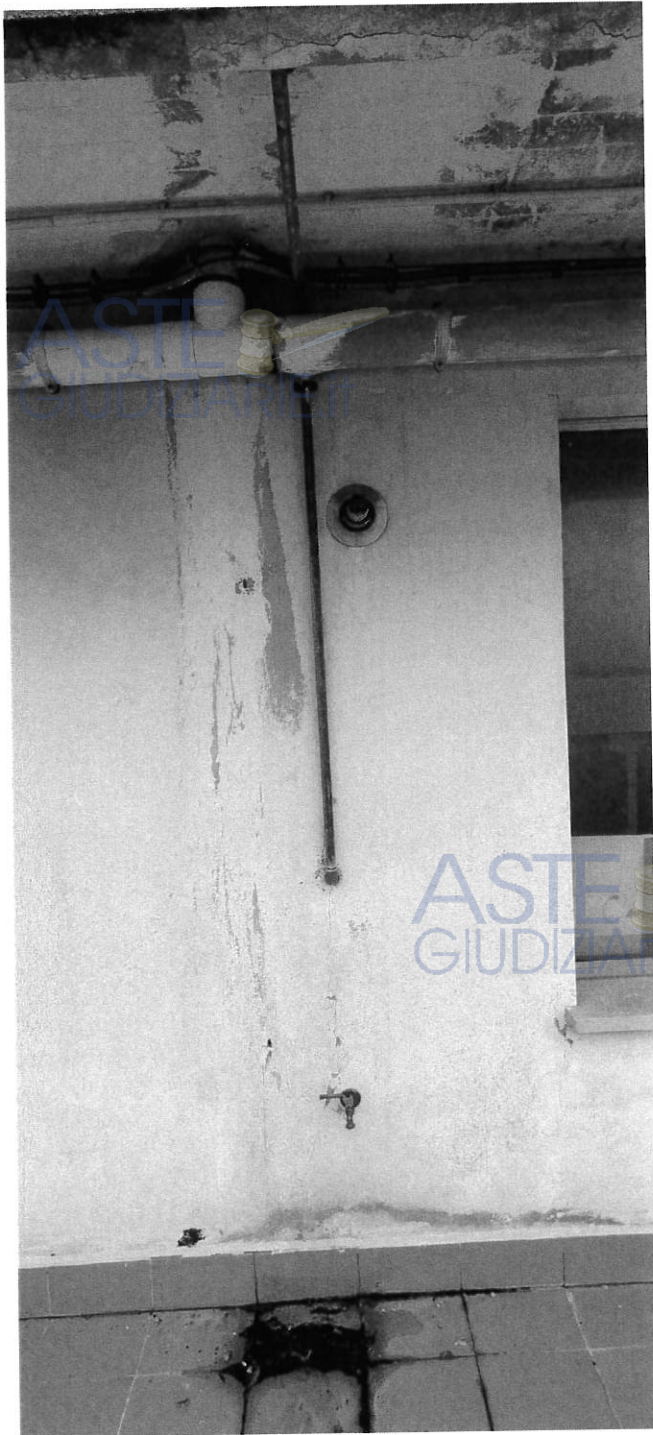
Il prospetto corrispondente alla sottostante area di infiltrazione AREA 3. Si osservi la presenza del pluviale e relativo tubo di allontanamento delle acque di gronda del tetto soprastante, di un rubinetto e della sottostante incrostazione di alghe che segnalano la presenza costante di acqua da gocciolamento .
